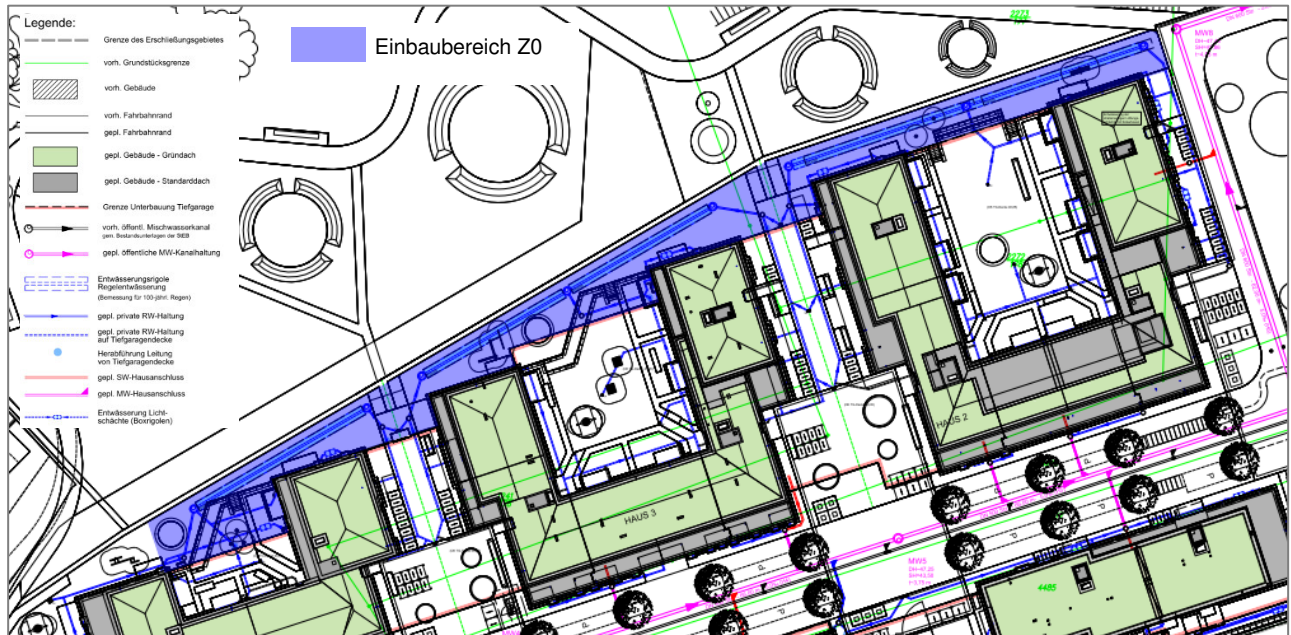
Auszug aus Lageplan private Entwässerung mit ergänzter Darstellung des Einbaus von Z0-Material im Bereich der Rigolen Haus 2 bis 4 (blau hinterlegt), (Quelle: Lageplan private Entwässerung - Grundstück Haus 2 bis 7, LK 038a, Fredersdorf Consulting, Stand: 24.11.2021)
